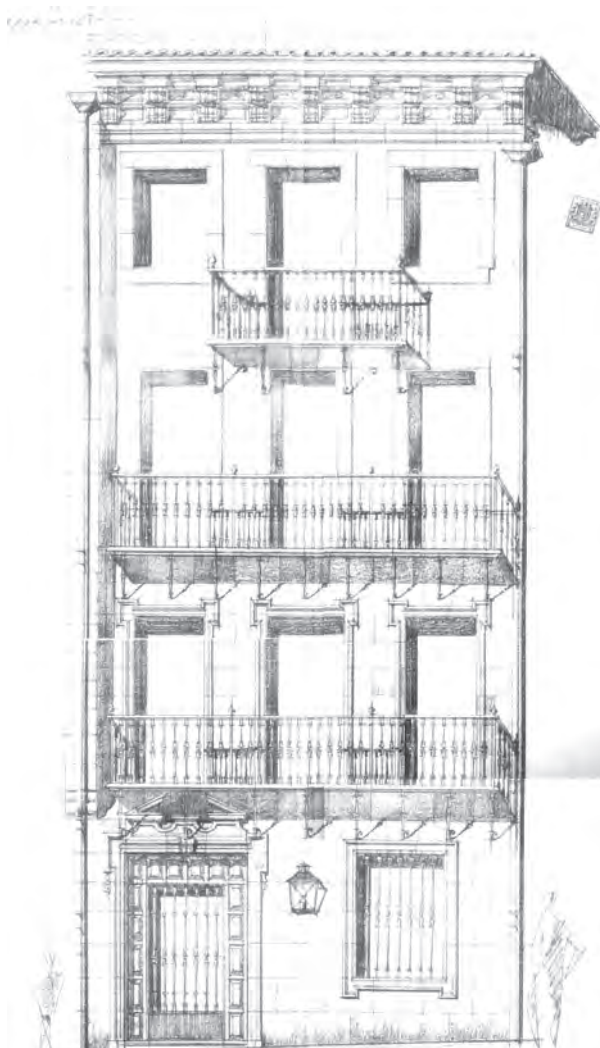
15. 1970. PLANO DE LA FACHADA PRINCIPAL
